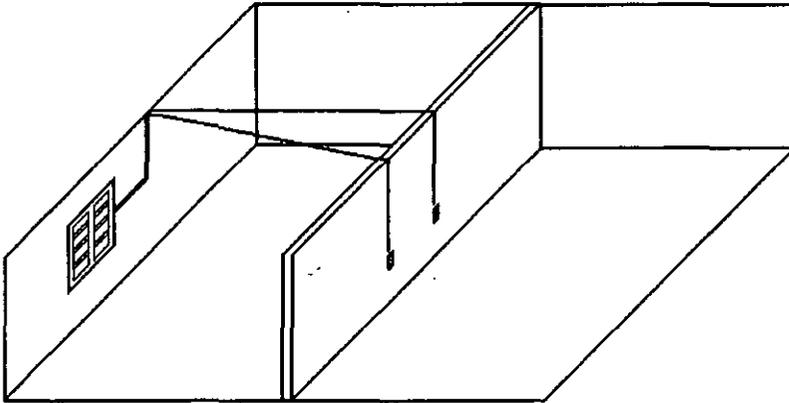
Esquema del subsistema Cableado Horizontal.
